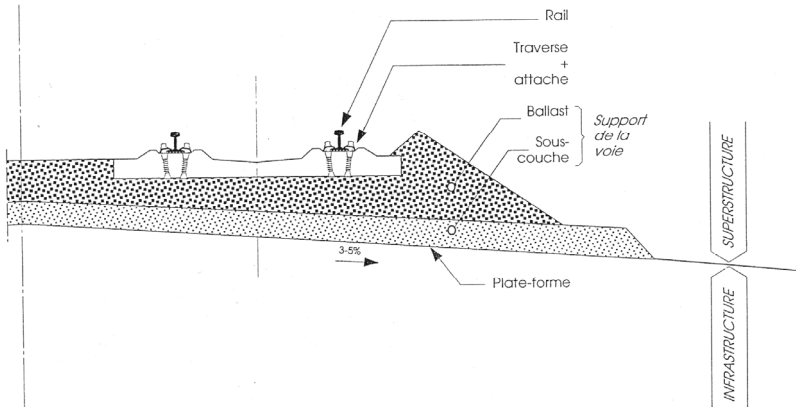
Structure d'une voie ferrée ballastée (Profillidis 2000)
